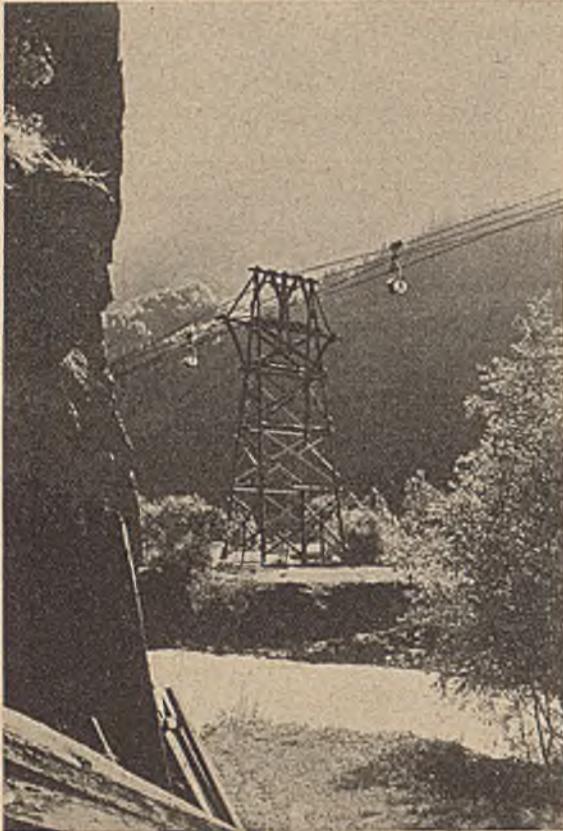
Holzerner Stütze der Drahtseilbahn neben der Poststraße Innertkirchen—Guttannen.
